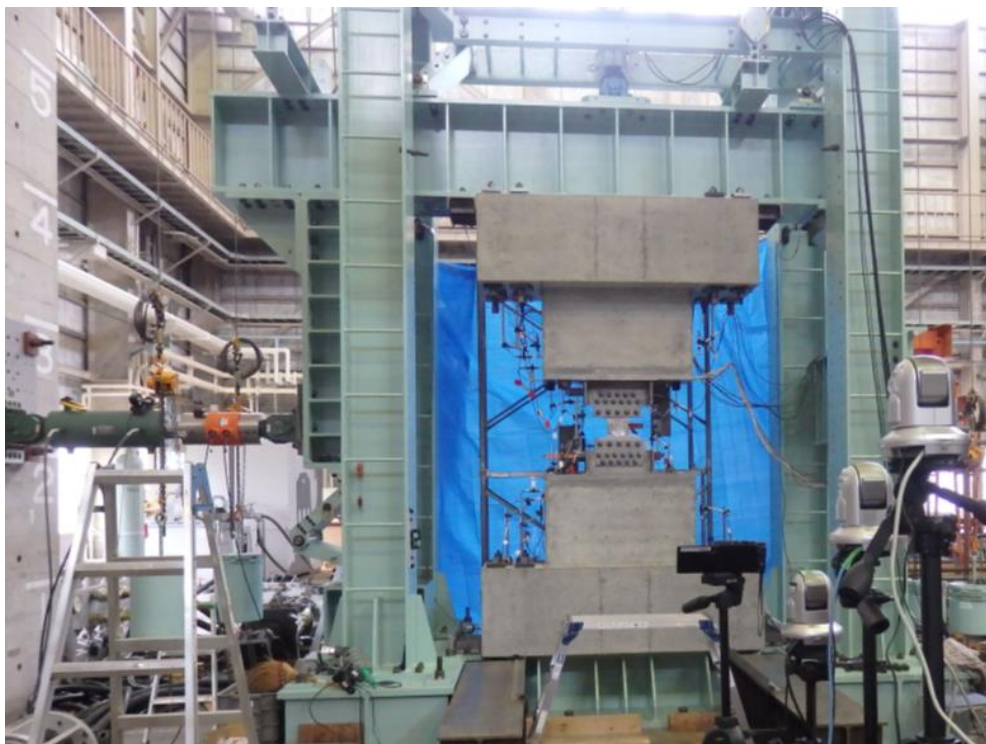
RC 造間柱試験状況(PC 鋼棒型)
